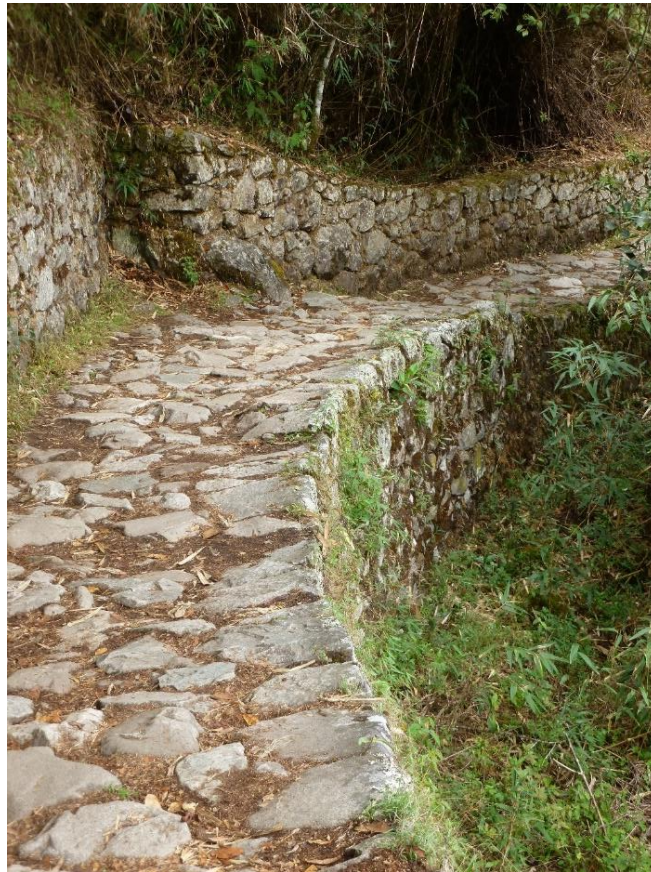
Tronçon pavé du *Qhapaq Ñan* menant au Machu Picchu (crédits photo : David Barreiro)
